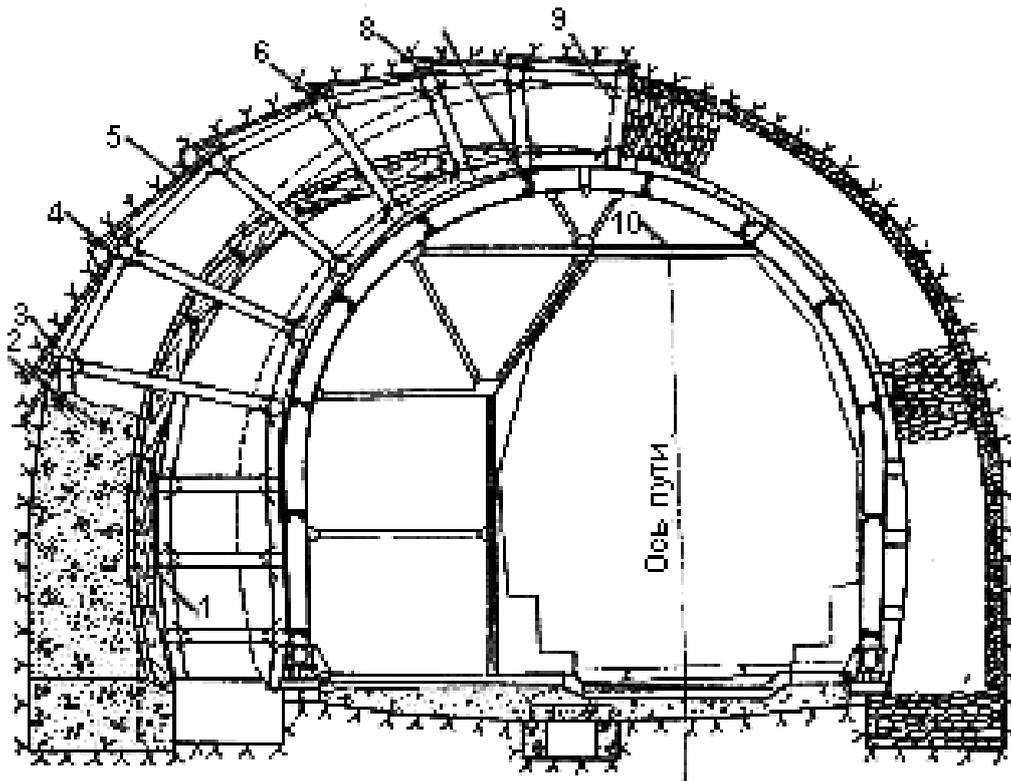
Бетонирование новой обделки: 1 – деревянное опалубочное кружало; 2 – новая обделка из бетона; 3 – лонгарина; 4 – скоба; 5 – марчевана; 6 – филата; 7 – клинья; 8 – опалубка; 9 – штендер; 10 – защитная обшивка из досок и кровельного железа
